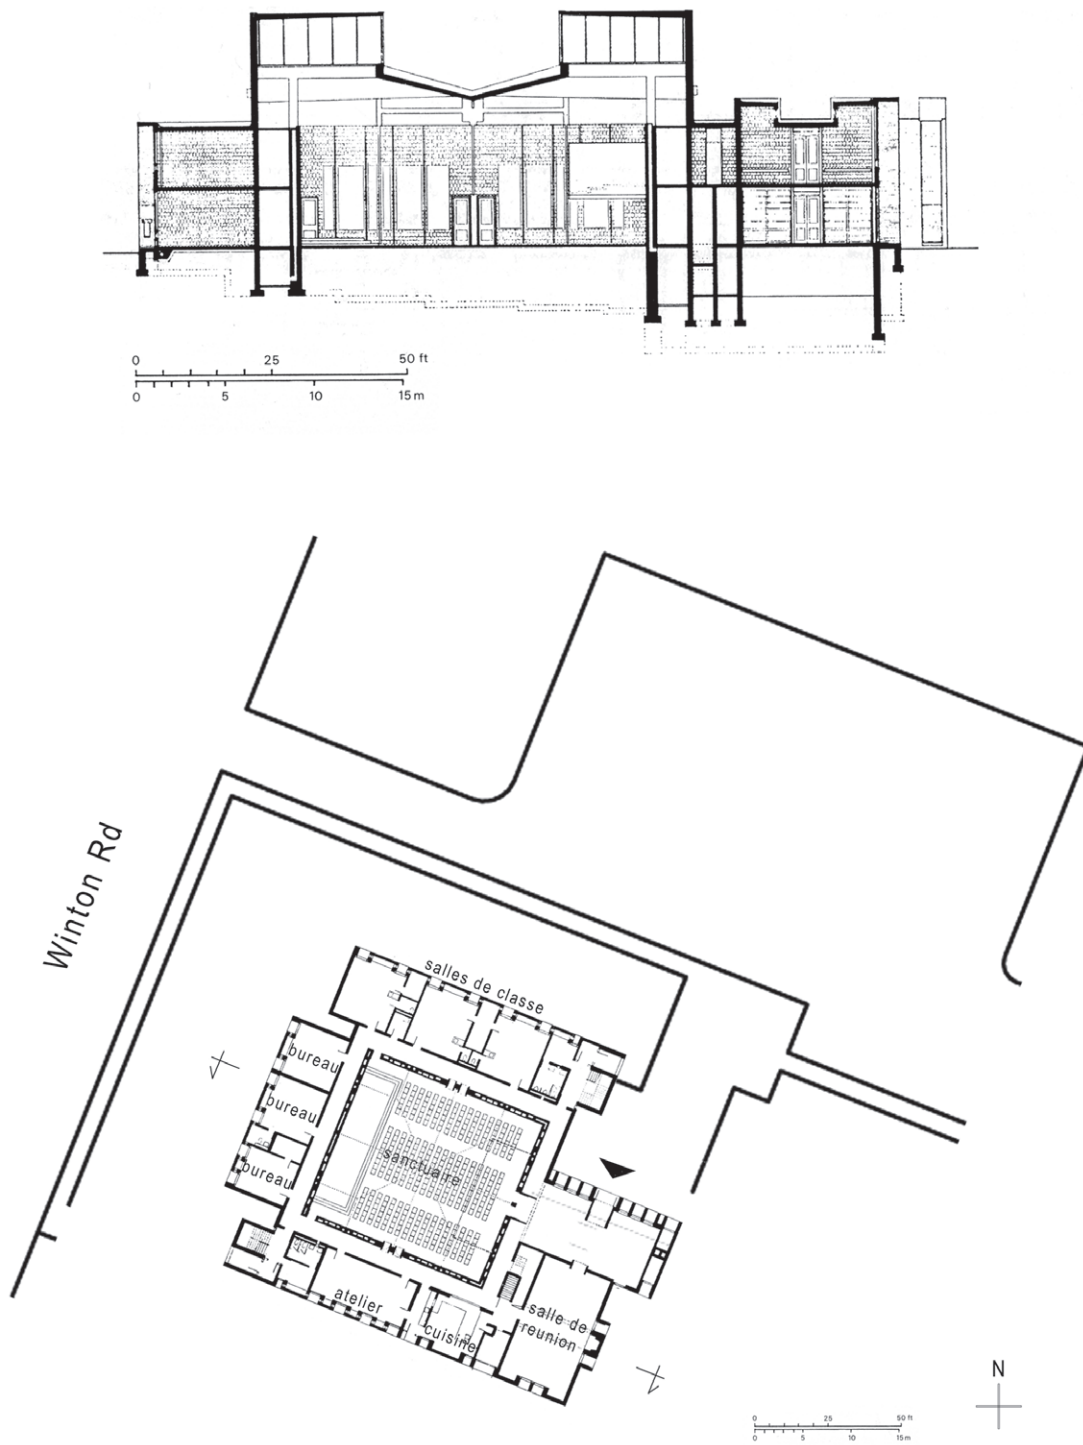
et 44. Coupe et plan de la version finale. Janvier 1961.
